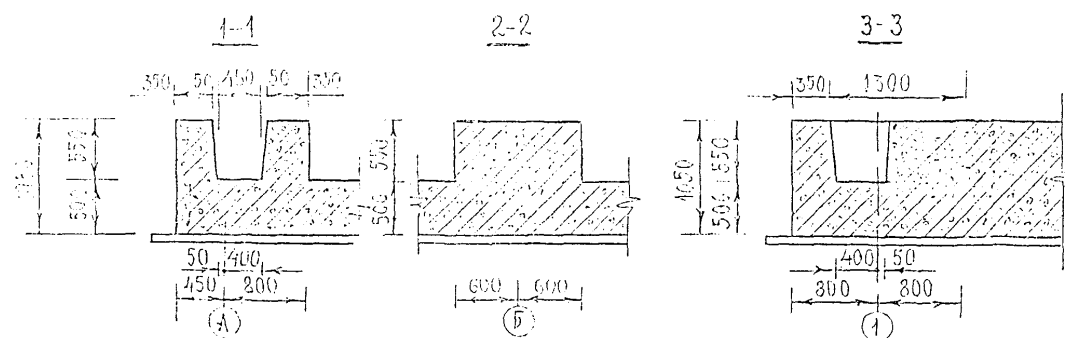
ФУНДАМЕНТНАЯ ПЛИТА.
